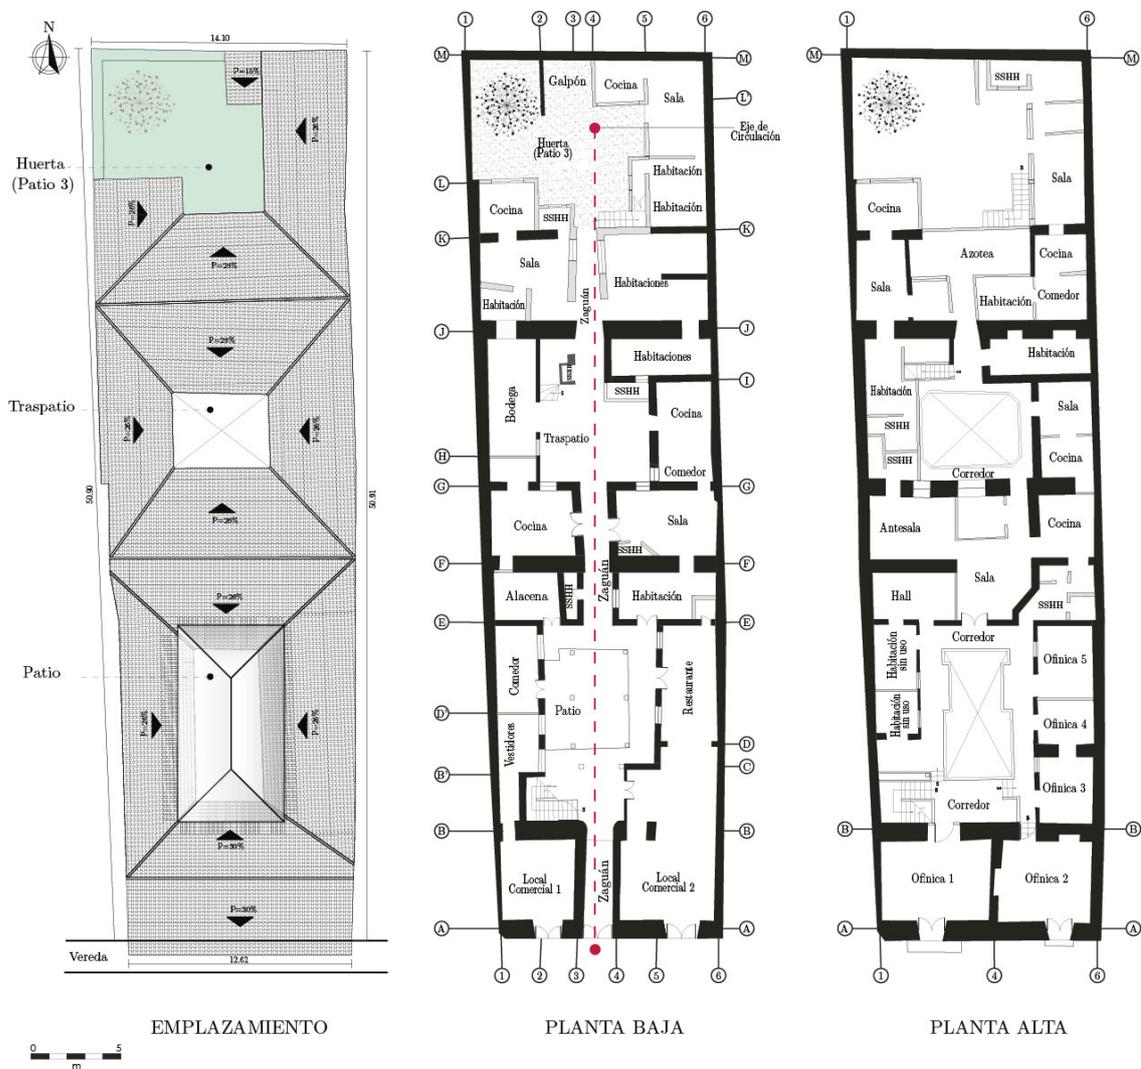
Emplazamiento, Planta Baja y Planta Alta
